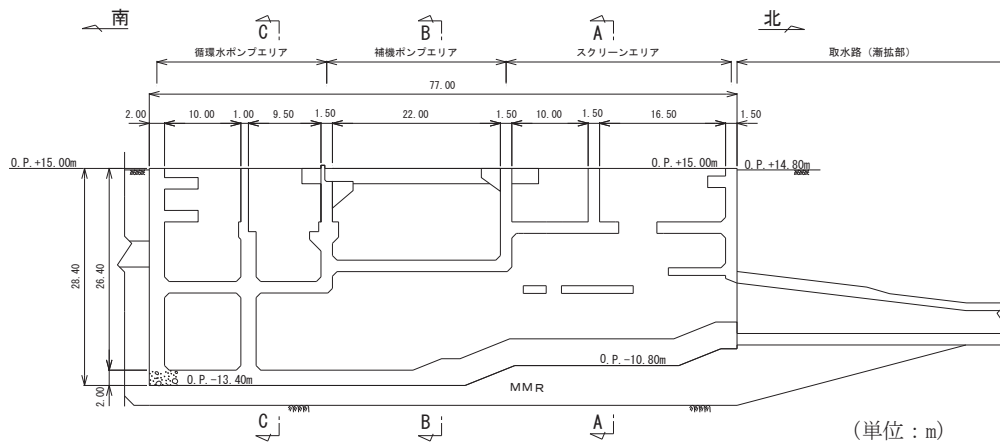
海水ポンプ室断面図 (E-E 断面, 南北)
